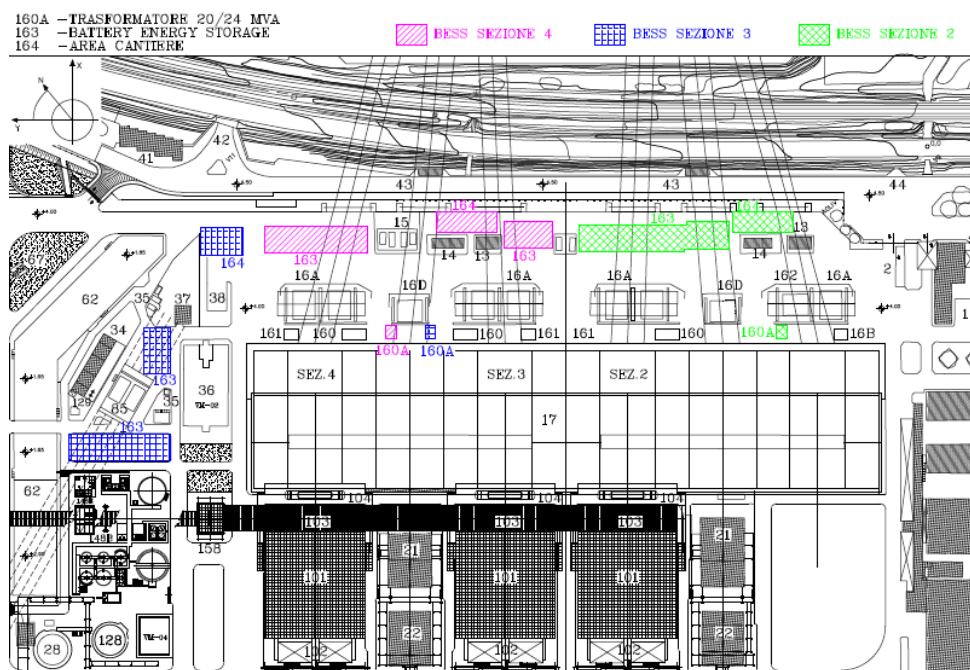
Ubicazione di dettaglio dei sistemi ESS e delle aree di cantiere (temporanee)
